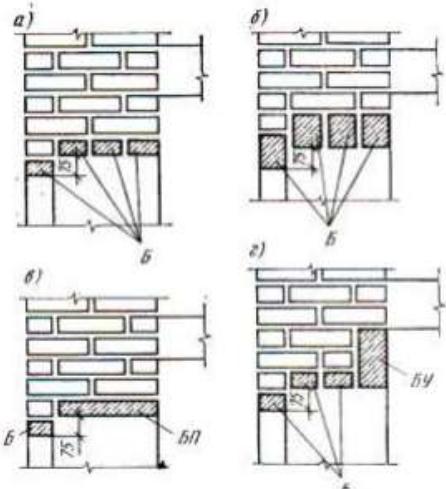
Сборные железобетонные перемычки: а, б - брусковые (тип Б); в — плитные (тип БП);
